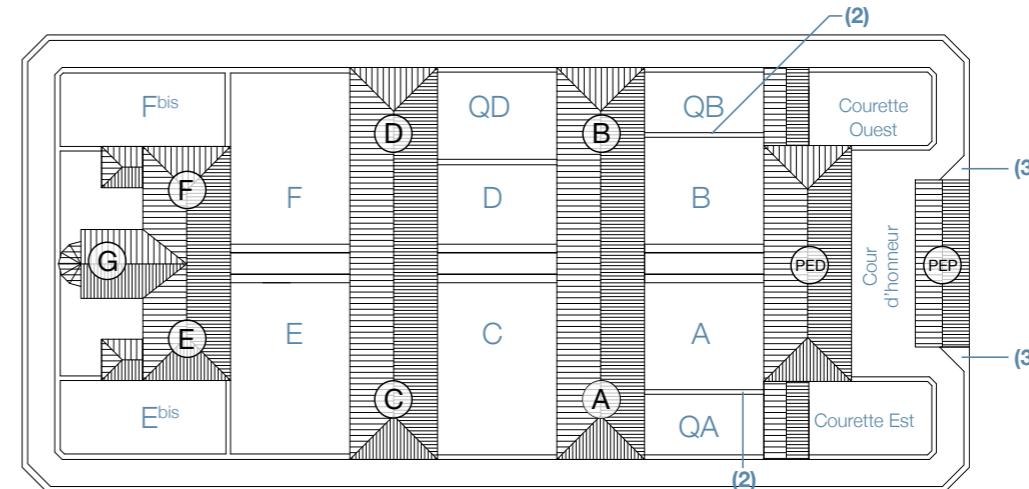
Plan de toiture supposé en 1947, d'après photographie aérienne. Source: Croisée d'archi
